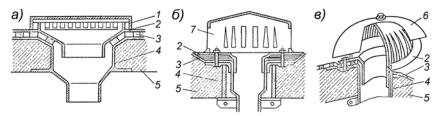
Водосточные воронки: 1 – решетка; 2 – рама; 3 – слой гидроизоляции; 4 – корпус; 5 – перекрытие; 6 – струевыпрямитель
